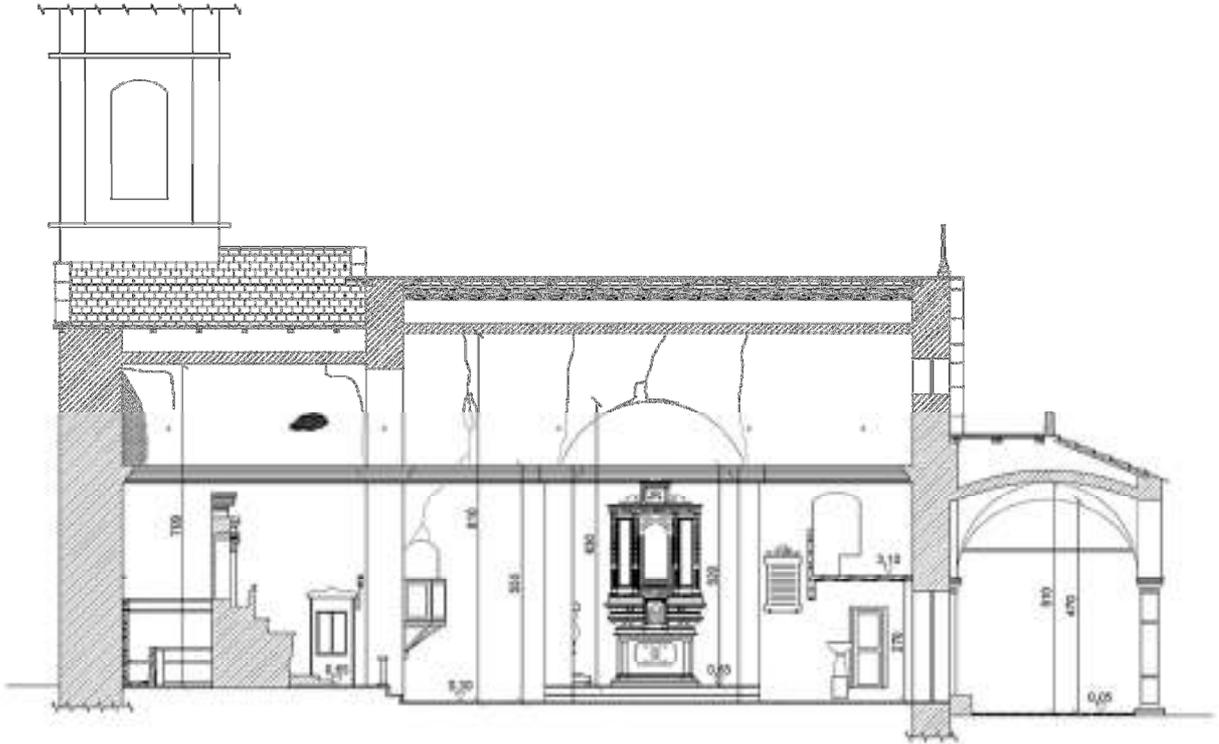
Sezione longitudinale C-C (Fonte: Tavola 3E)
